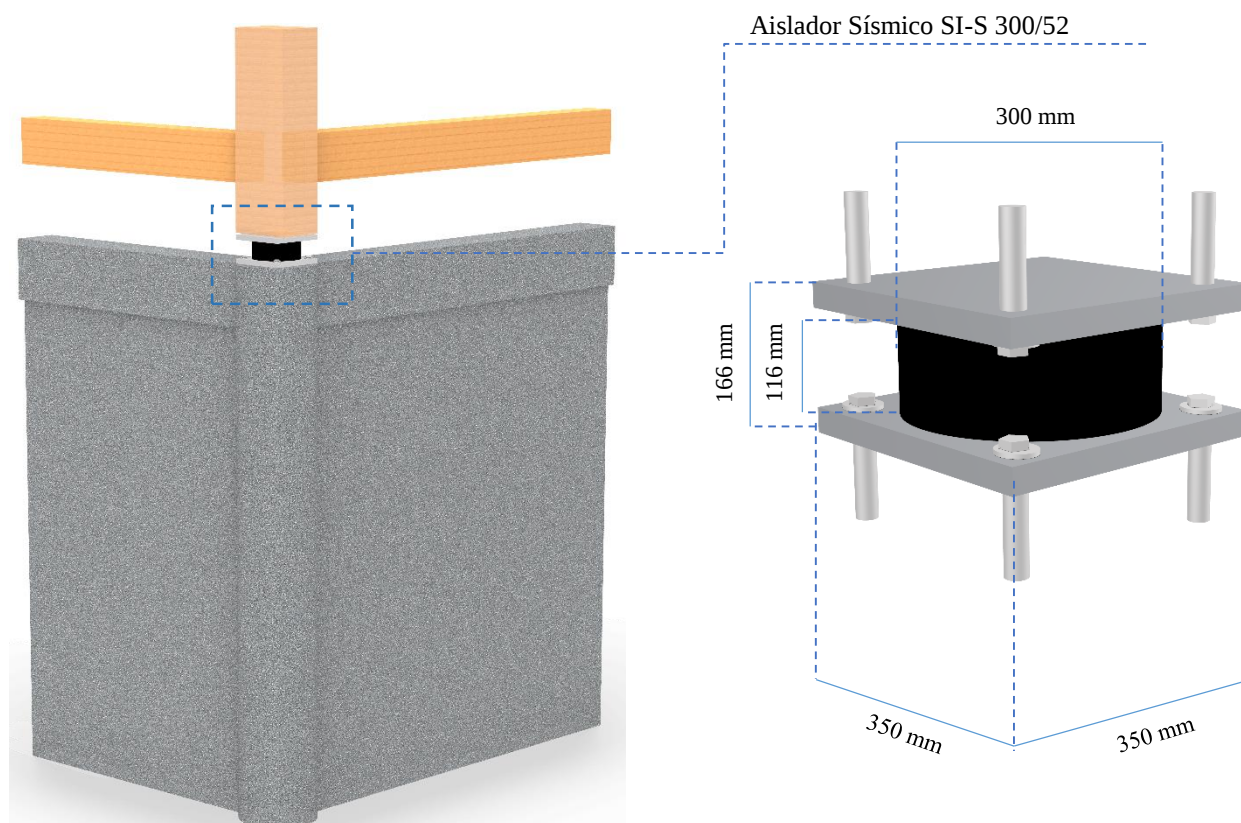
Corte estructural diseño y detalle Aislador sísmico primer nivel. Elaboración Propia.
